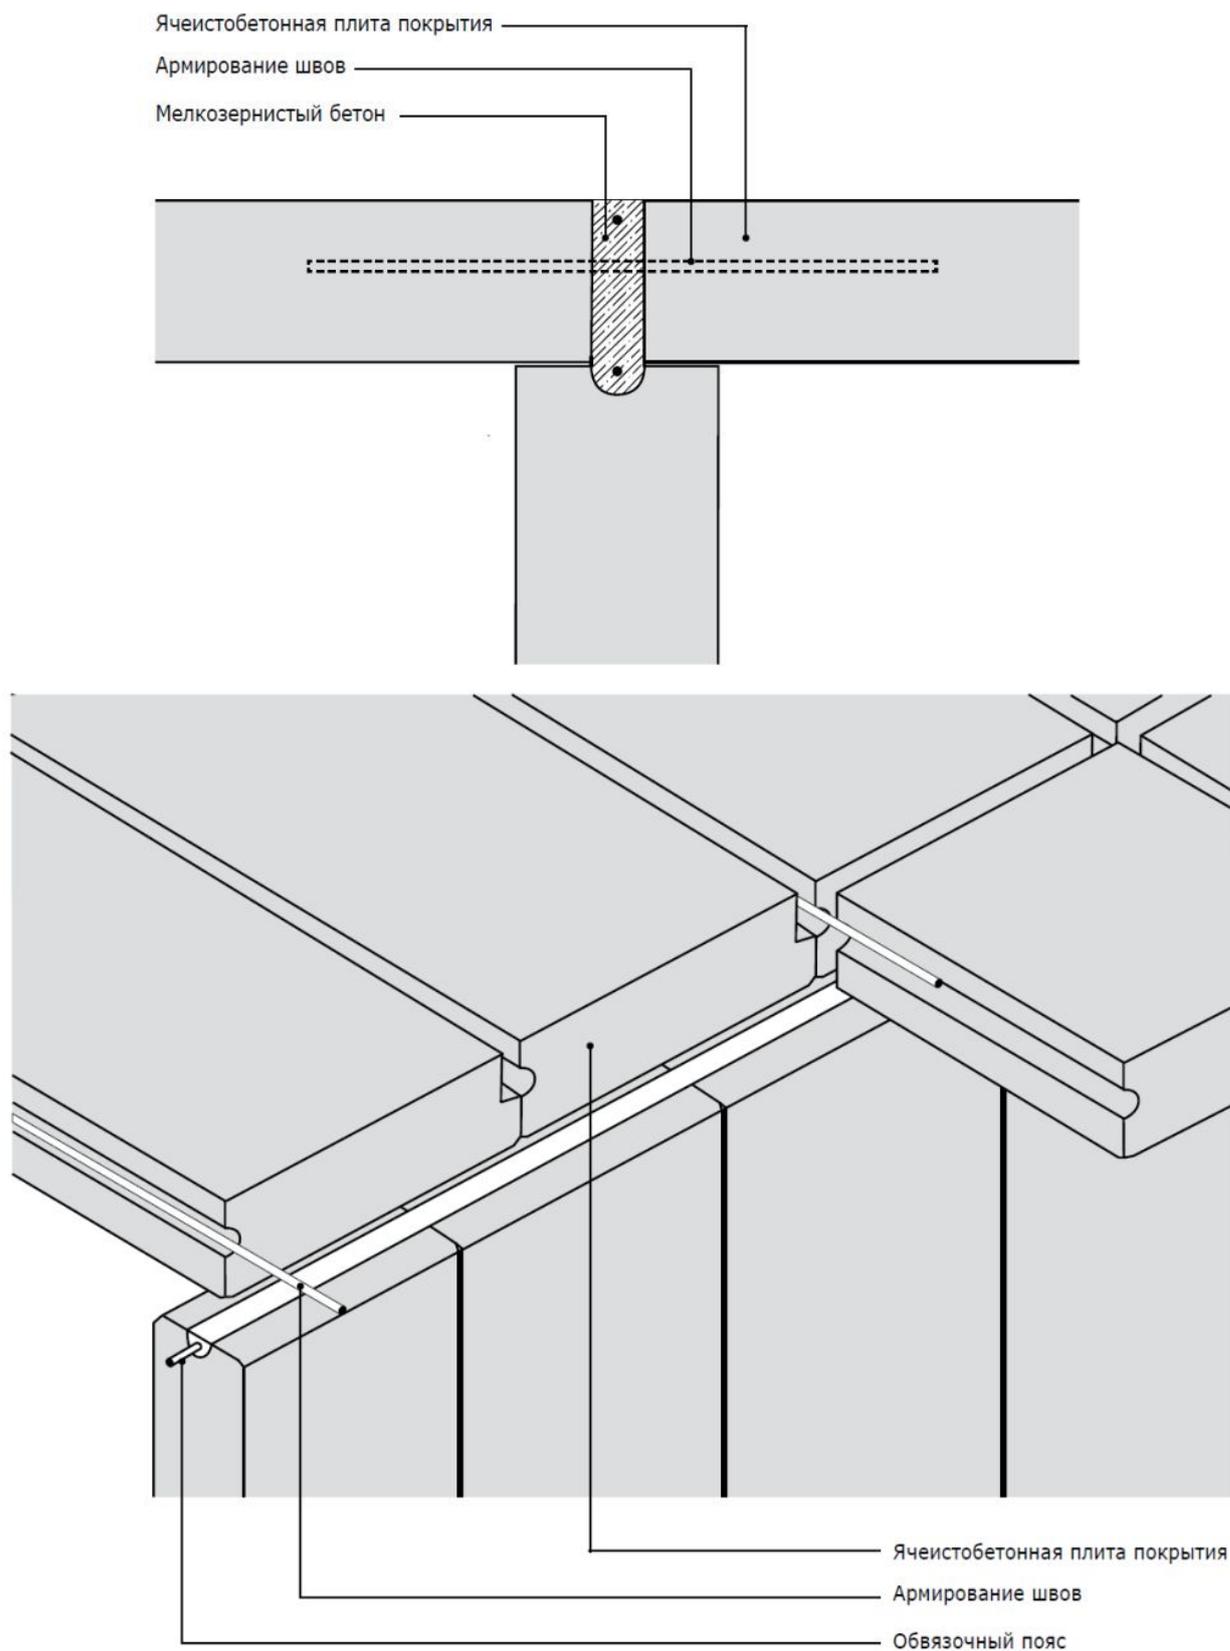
Зона сопряжения стена-перекрытие. Двустороннее опирание панелей перекрытия на стеновые панели с армированным замоноличенным пазом в верхней плоскости, обвязочный пояс в уровне перекрытия
